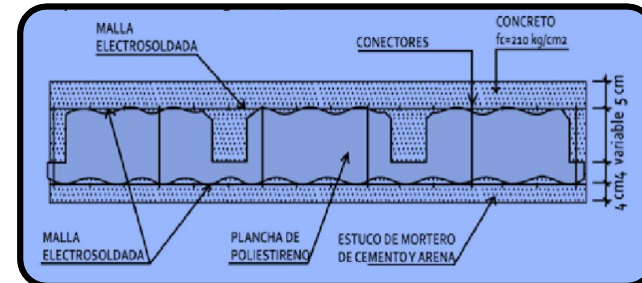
Panel losa con dos nervaduras para armado de viga (PL2).
